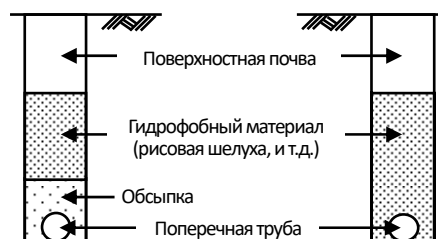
Поперечное сечение Основного закрытого дренажа
